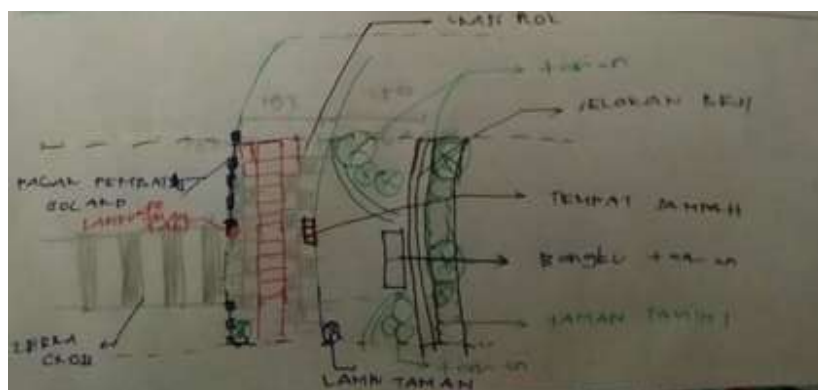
Rencana *Site Plan* Segmen 1 pada Area 2
